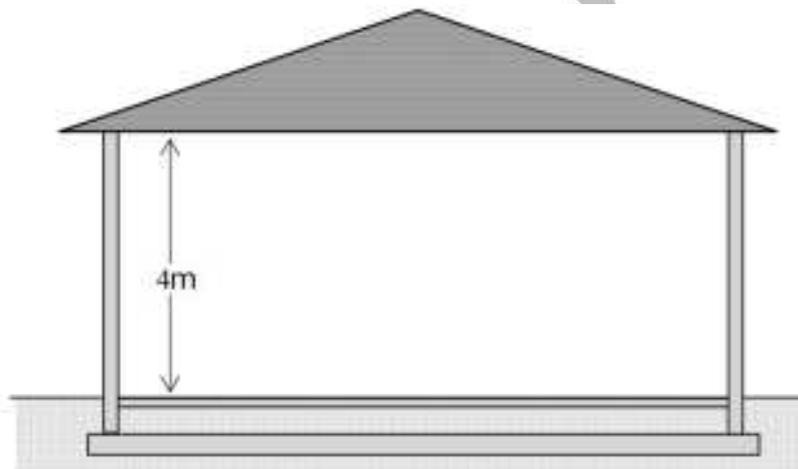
exemple d'un bâtiment de type 5(c)m
